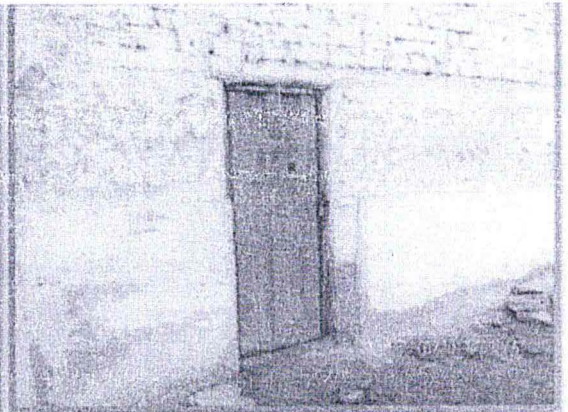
Puerta de ingreso a la unidad fiscalizable ubicada en el Pasaje Santa Rosa s/n
